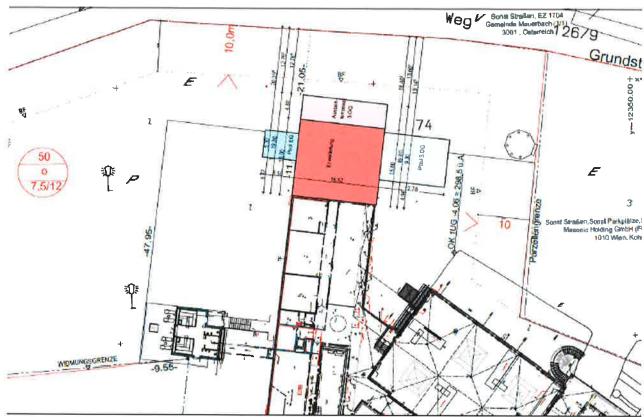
Ausschnitt des Lageplans (Verf.: Gemeinhardt, Planungs u. Bauberatungs GmbH, Stand: 13.11.2020)
